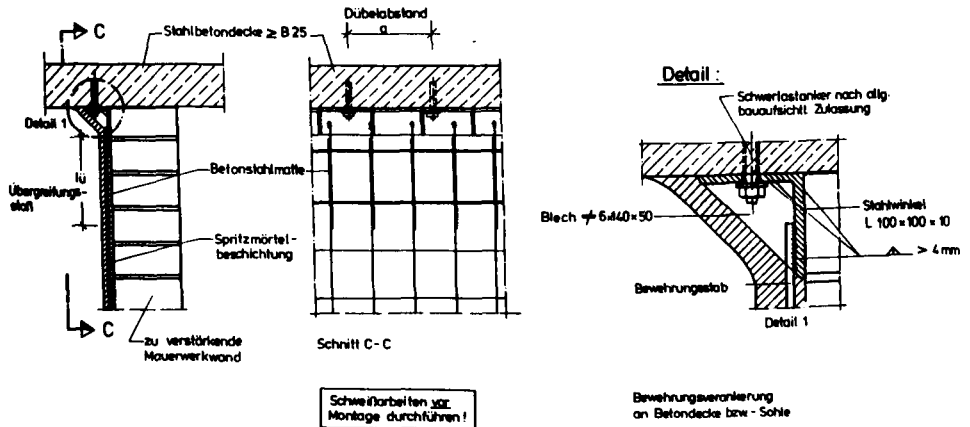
Zugfeste Endverankerung der Betonstahlbewehrung mit angedübelten Stahlwinkeln
